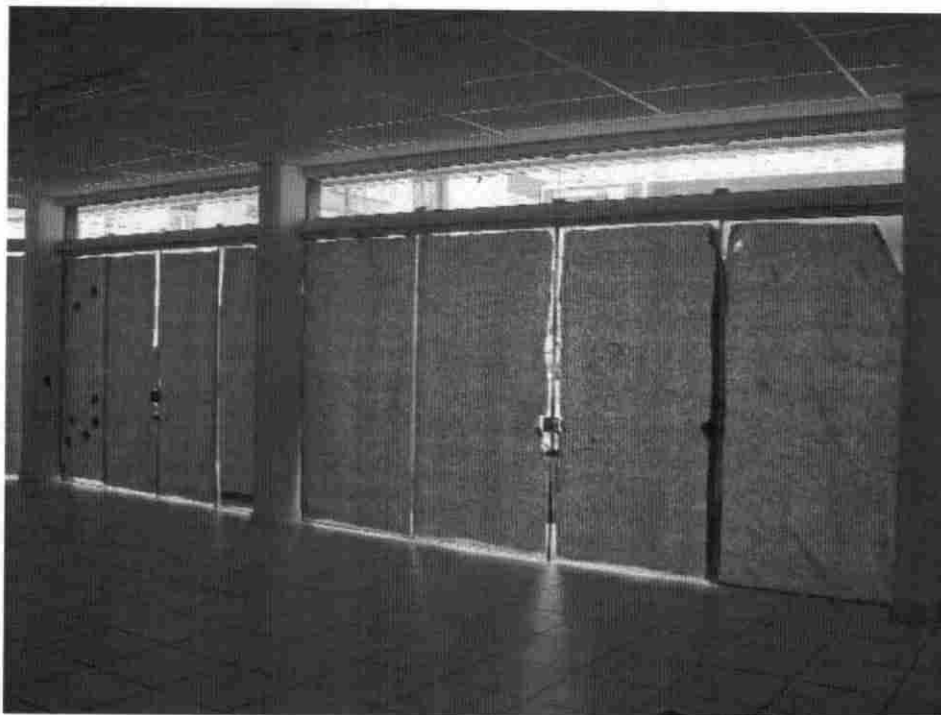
Pavimento térreo. Destaque para as portas de acesso à edificação.
